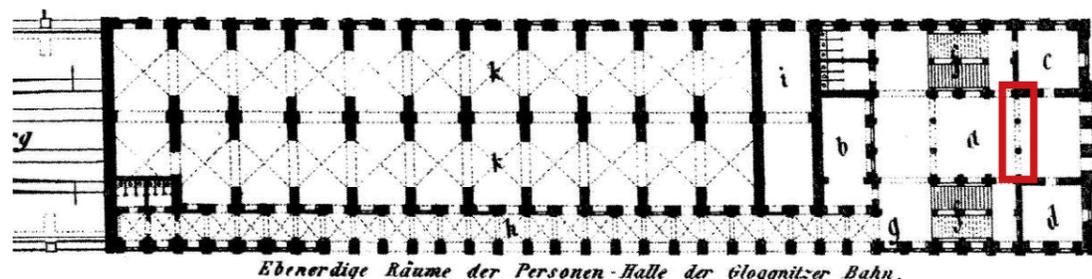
Grundriss Erdgeschoss Gloggnitzer Bahnhof, 1842
